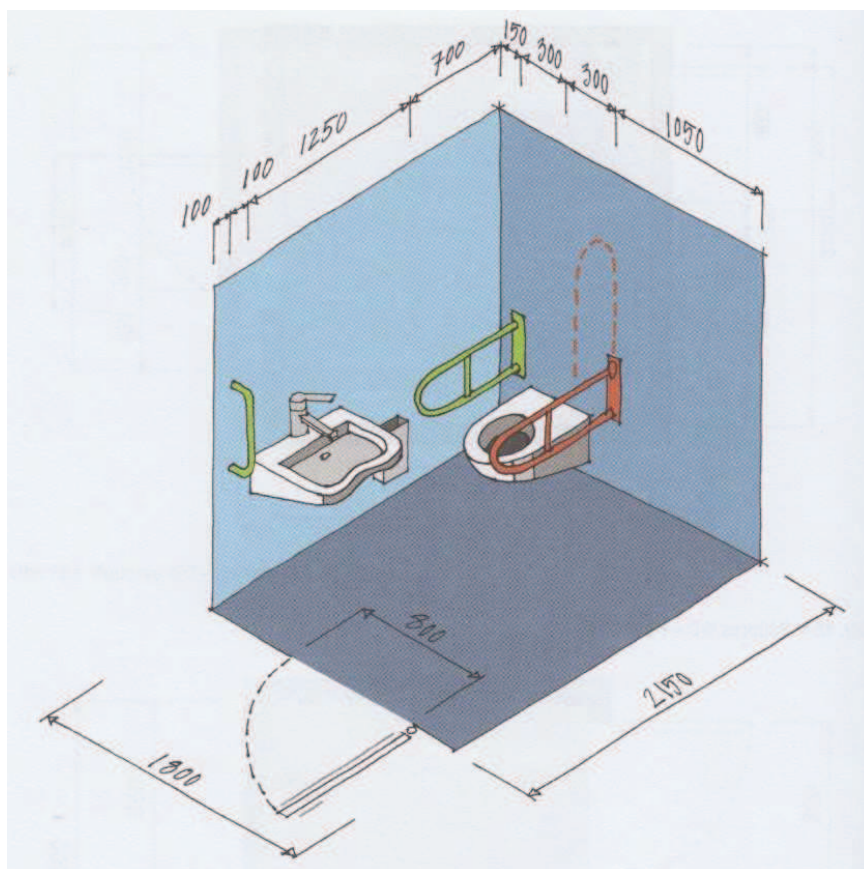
Půdorys WC - změna dokončené stavby (Budovy bez bariér, str. 88)
